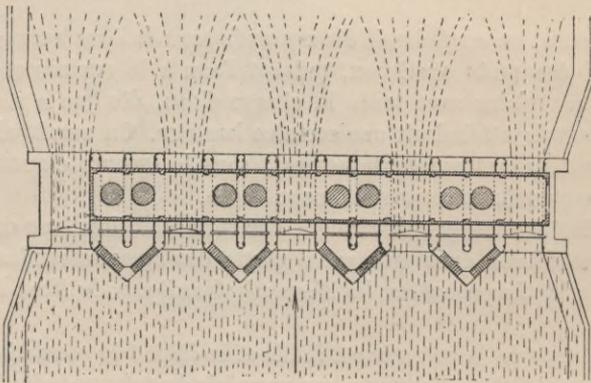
Plan d'une usine-barrage, système Saugey.
